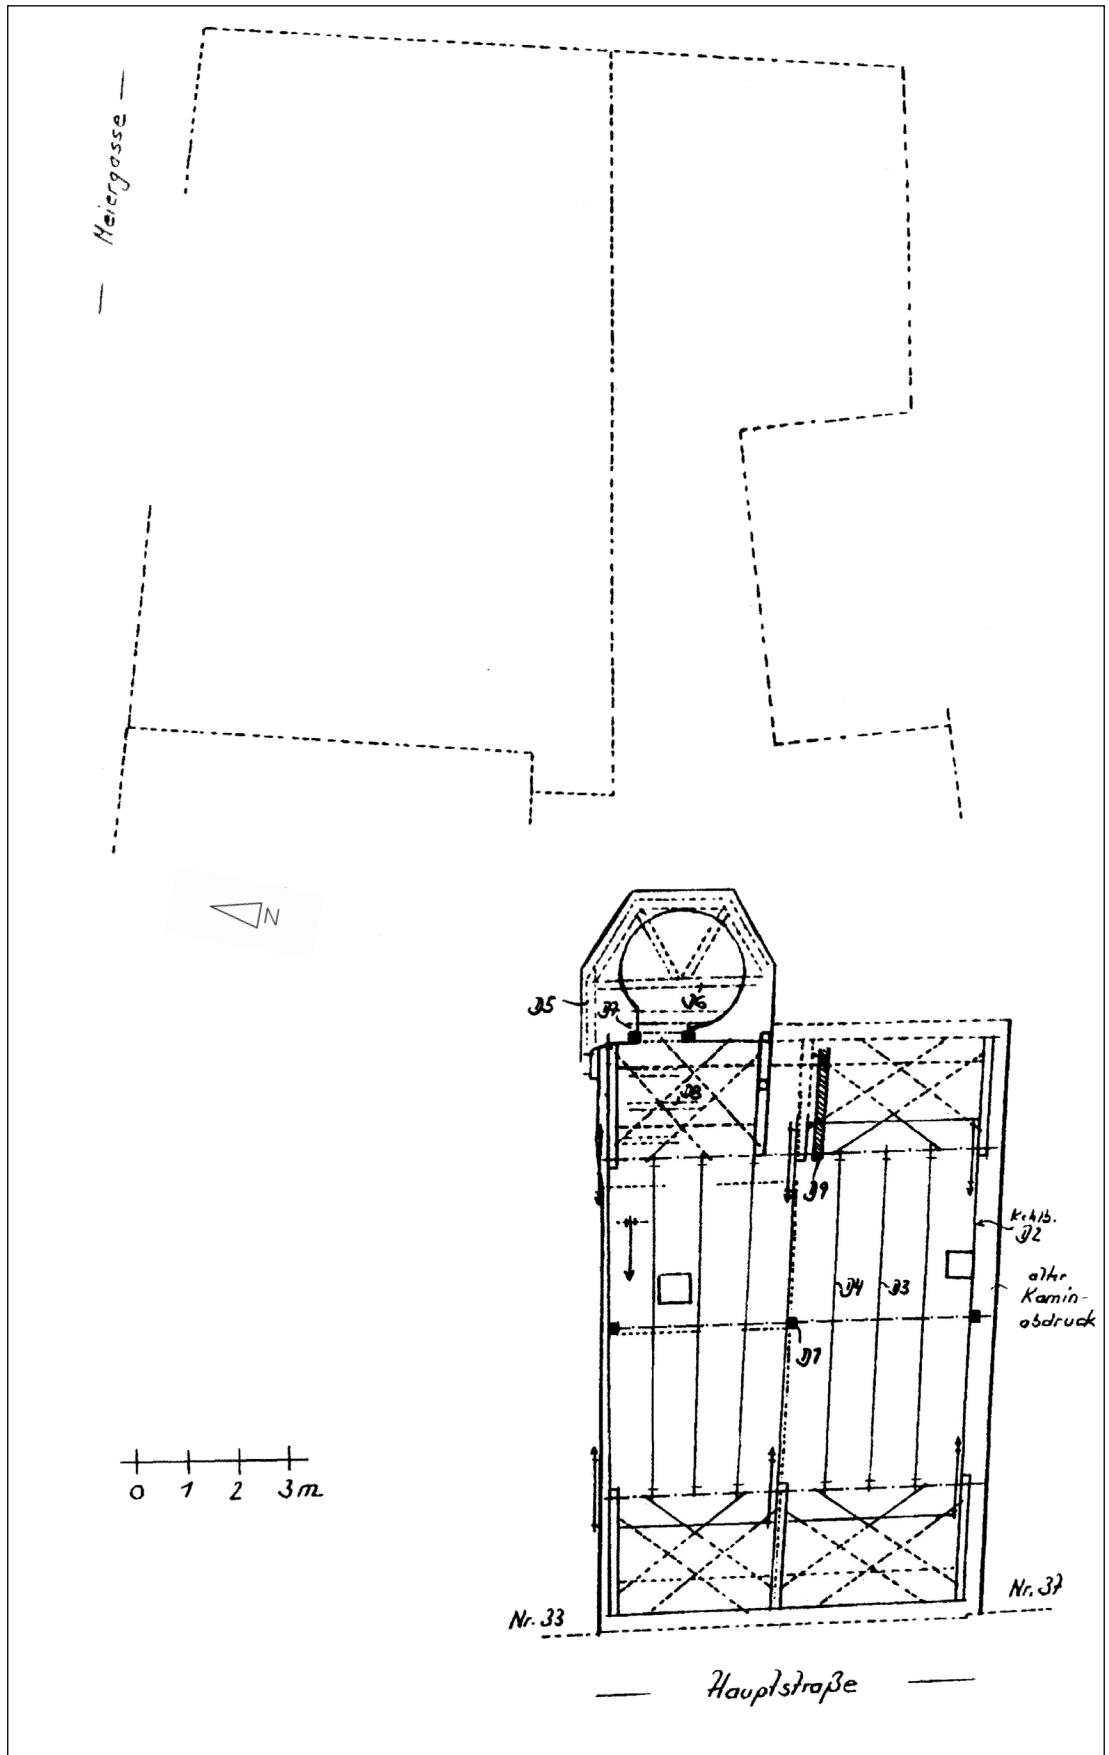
Hauptstraße 35, Grundriss 1. Dachgeschoss, M. 1:150.
